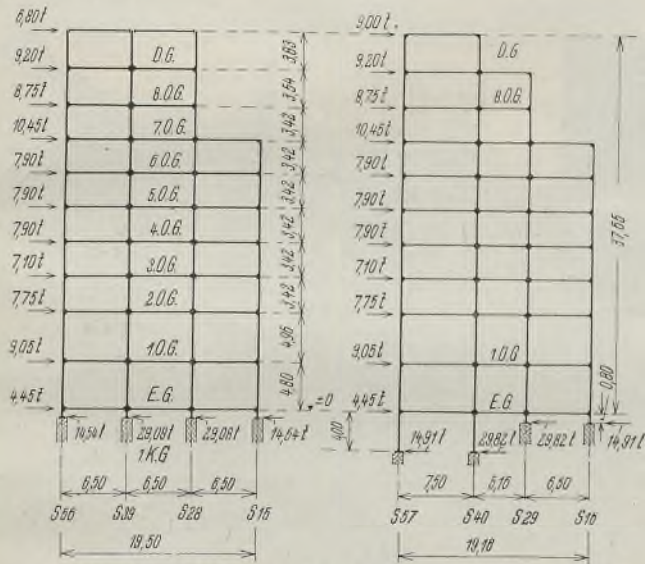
Belastungsschema der Stockwerkrahmen 56 ÷ 15 und 57 ÷ 16.
